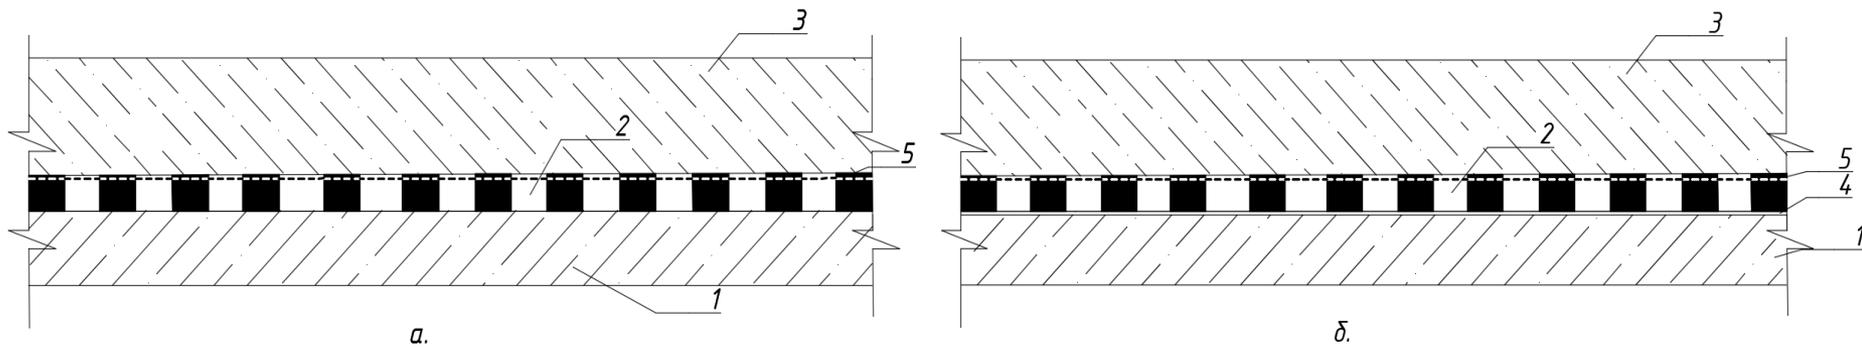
Бесшовная гидроизоляция лотковой (фундаментной) плиты с укладкой напыляемых составов с двухсторонней адгезией: а) без подстилающего слоя; б) с подстилающим слоем из нетканого геотекстиля.
